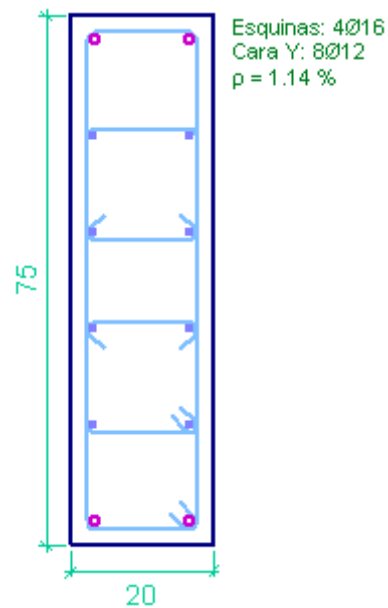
Detalle de armado de columna CE3 para planta baja.
